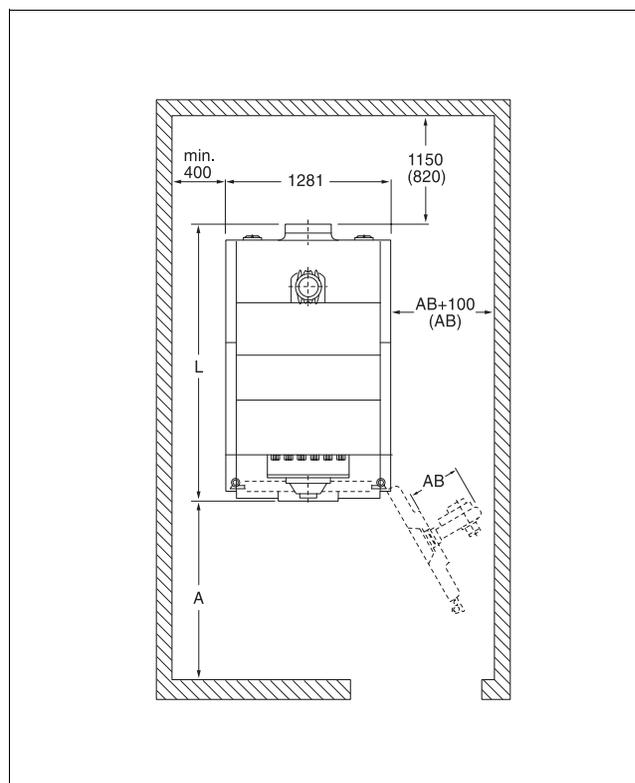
Aufstellraum mit Heizkessel (Maße in mm)
